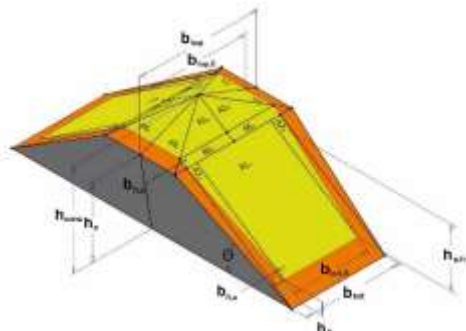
Reduzierte Ausbruchfläche der Betonrippe
